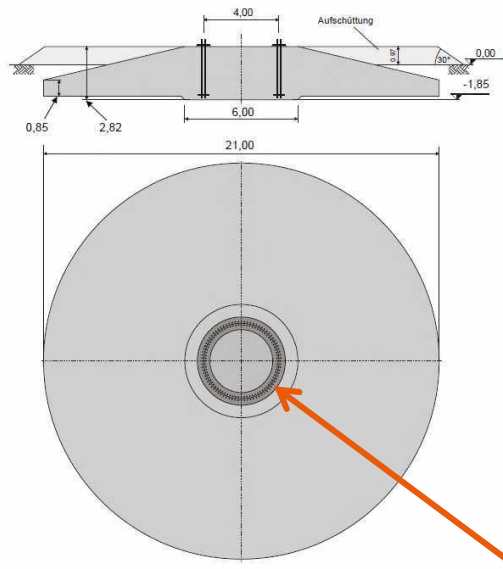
Schéma indicatif d'une fondation type et de sa cage d'ancrage
